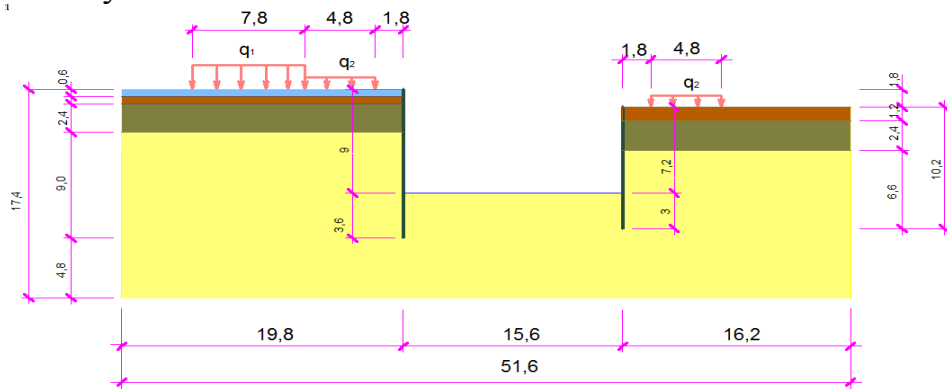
Схема конструкций ограждения котлована и нагрузок на многослойное основание
